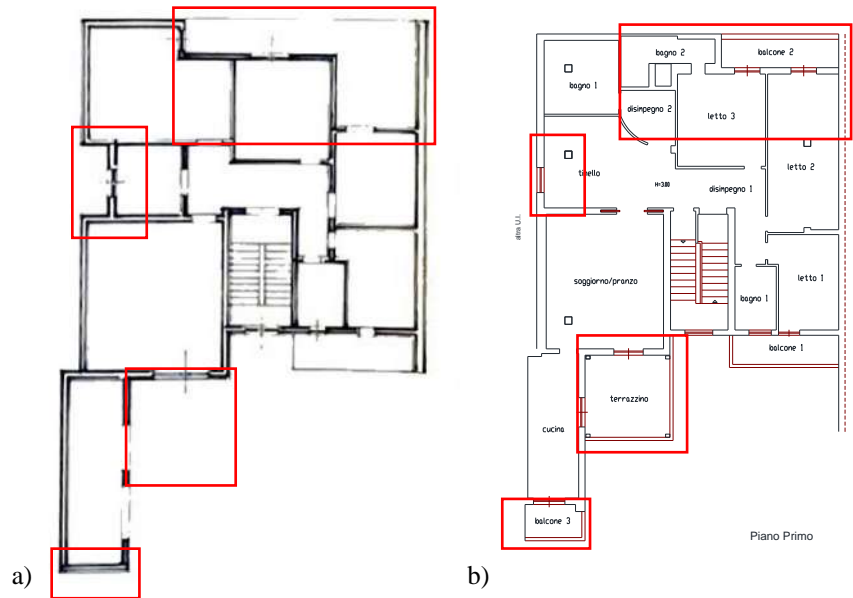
primo piano: a) Planimetria del titolo abilitativo; b) Planimetria stato di fatto
